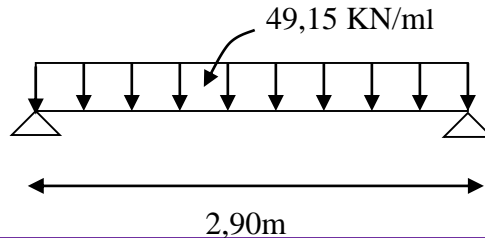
Schéma statique de la poutre à l'ELS.
